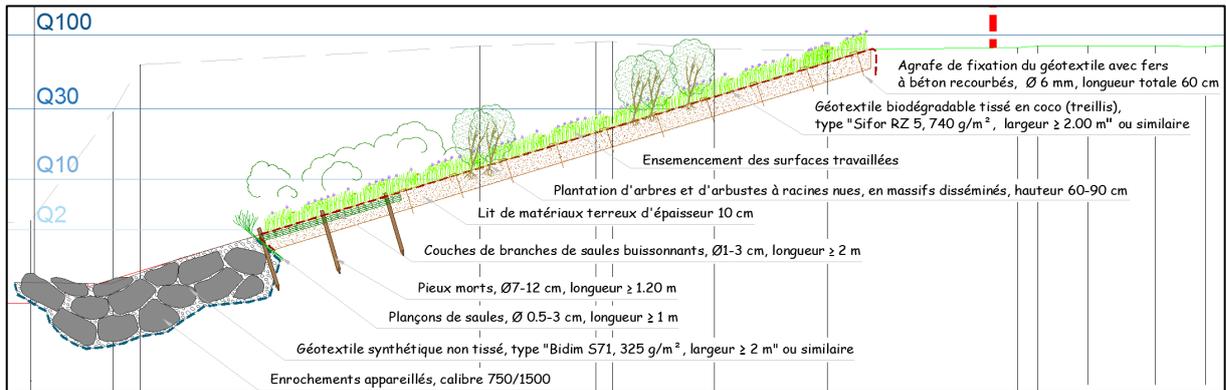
Coupe type renforcement du pied de berge en enrochements
